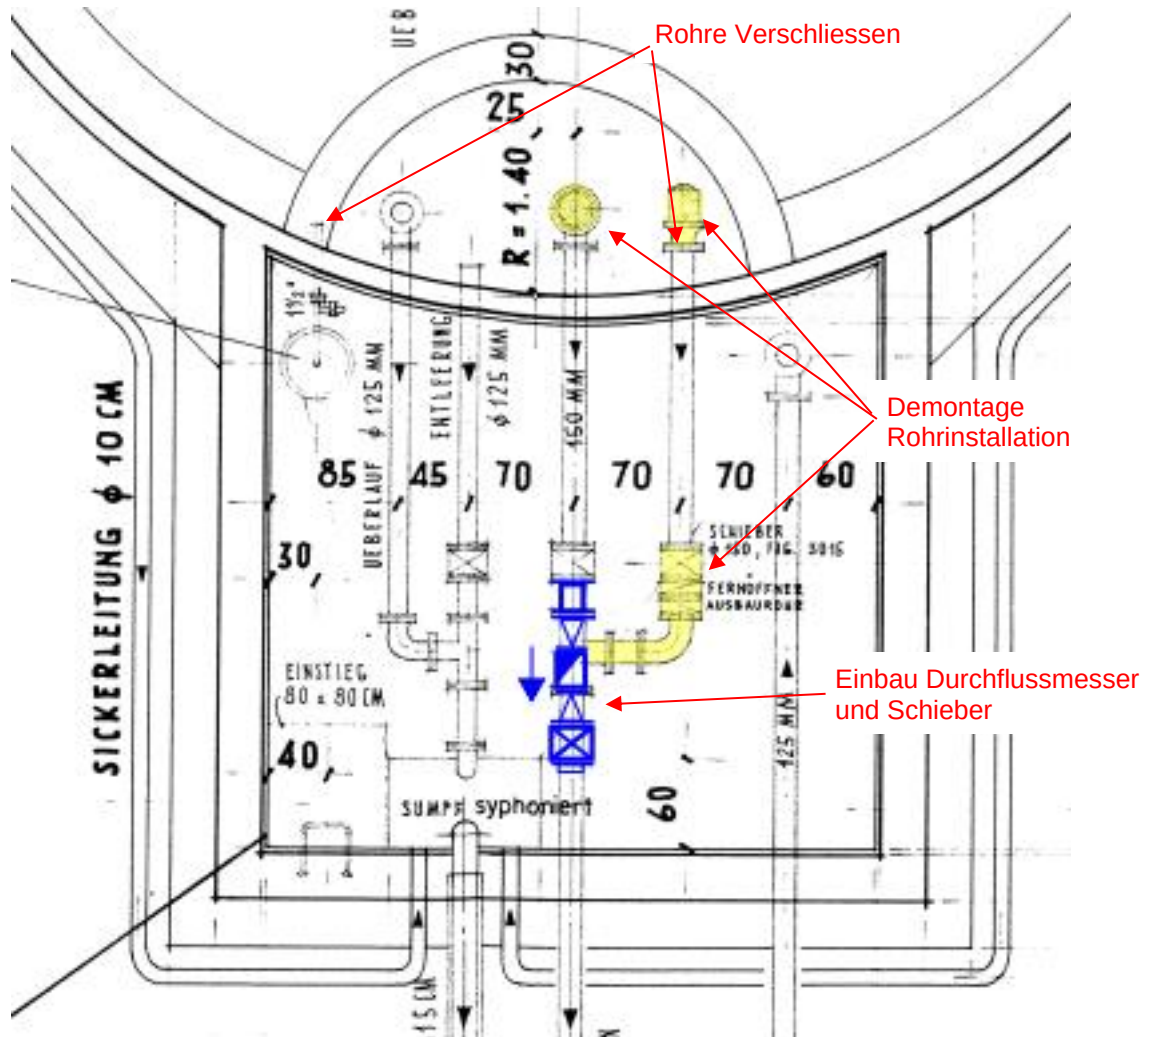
Geplante Massnahmen (Ausschnitt aus Plan Nr. WV 10/8, 04.05.1992)
